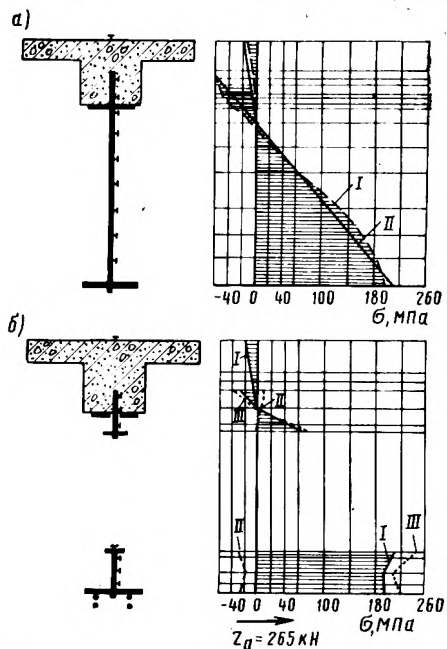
Эпюры нормальных напряжений в сталежелезобетонных балках на второй стадии нагружения
